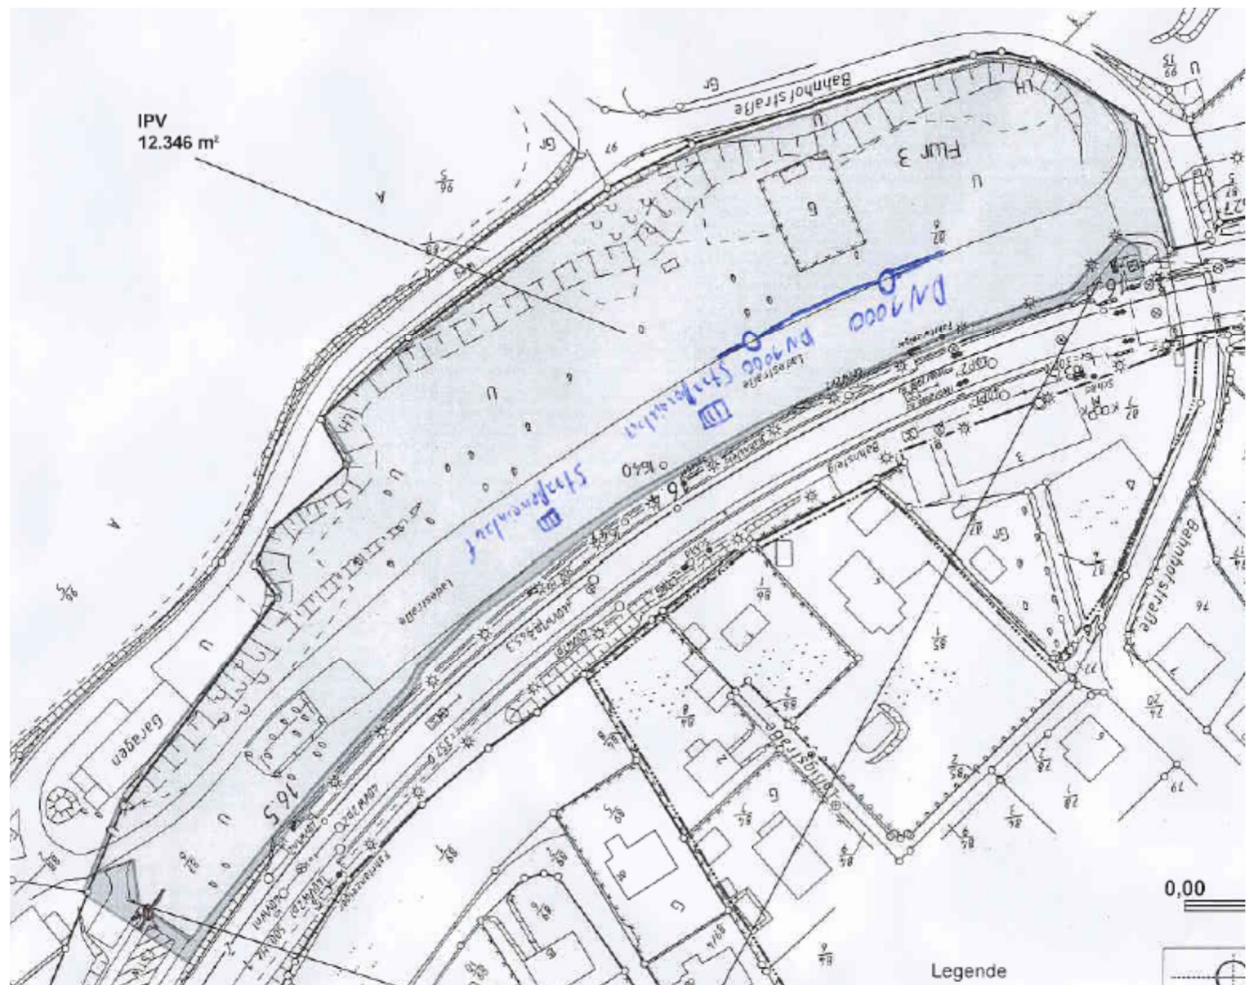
Plan aus dem Jahr 2013 vom Gelände mit Darstellung der Ladestraße
